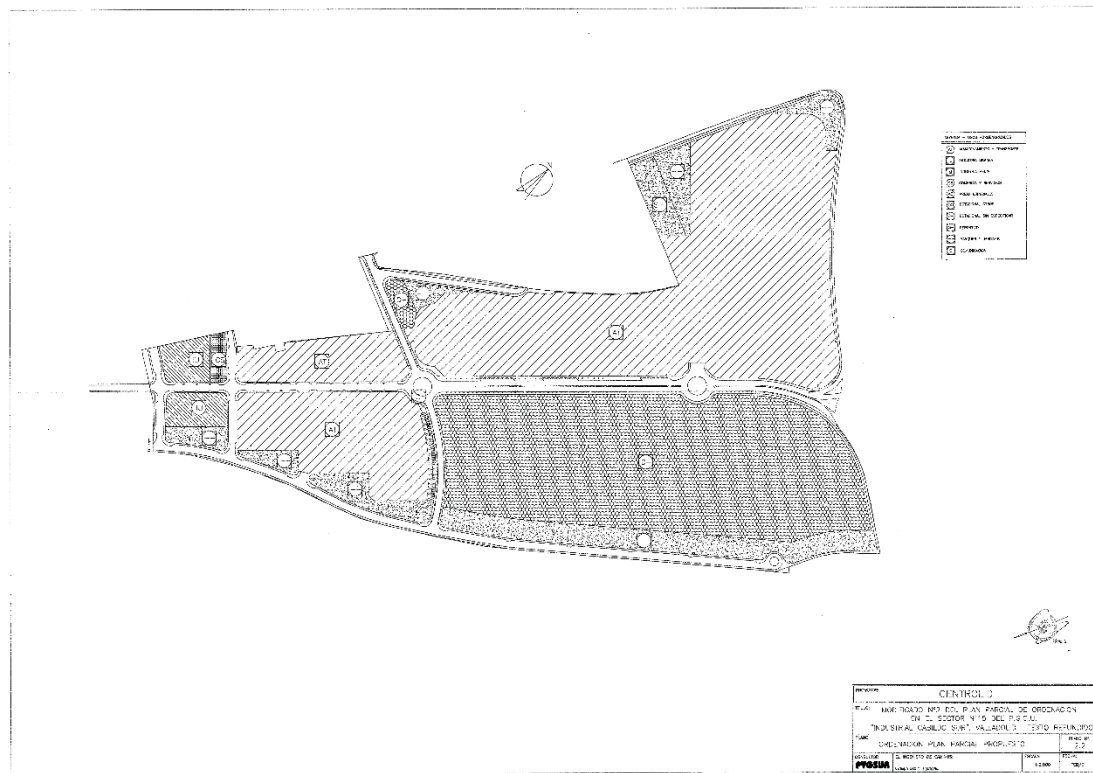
Plano de ordenación del Sector 6 (antes 15) en la modificación 1ª del Plan Parcial
